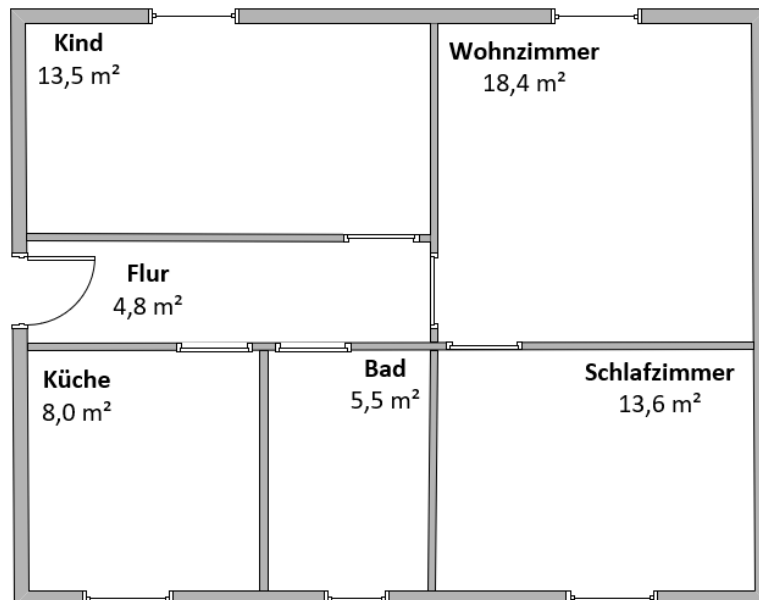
Grundriss Drei-Zimmer-Wohnung nach [16]
